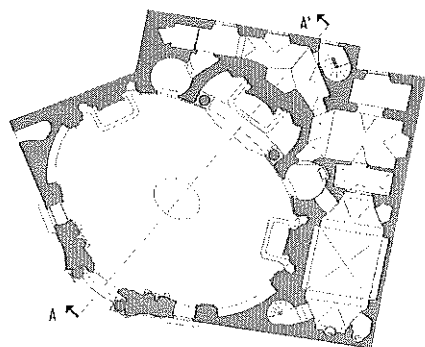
Planimetria della Chiesa di Santa Caterina a Lucca. Piano terreno
